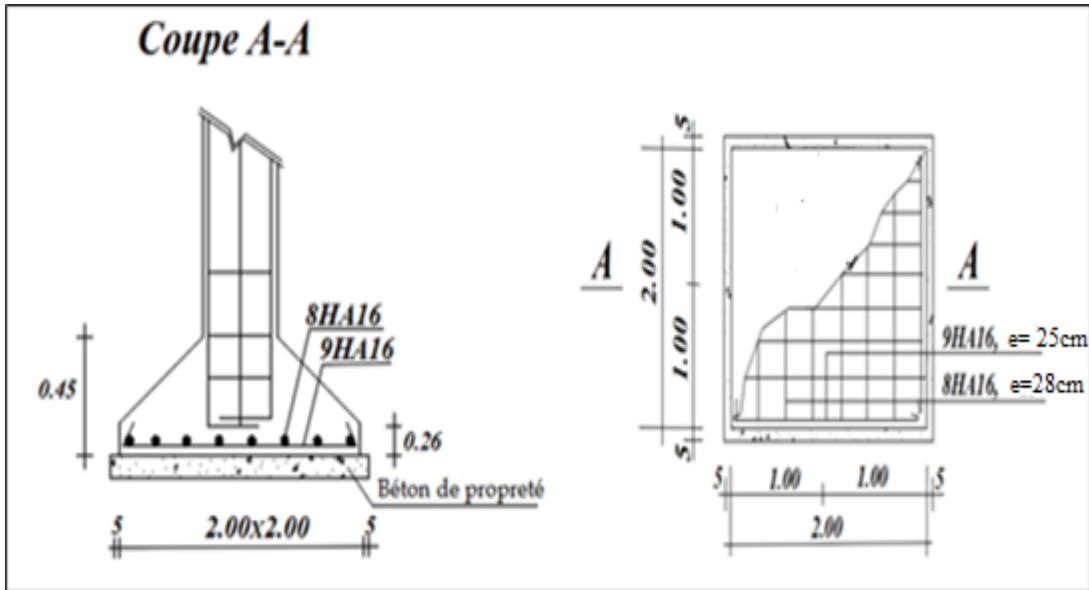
Exemple de ferrailage d'une semelle isolée sous poteau intermédiaire.
